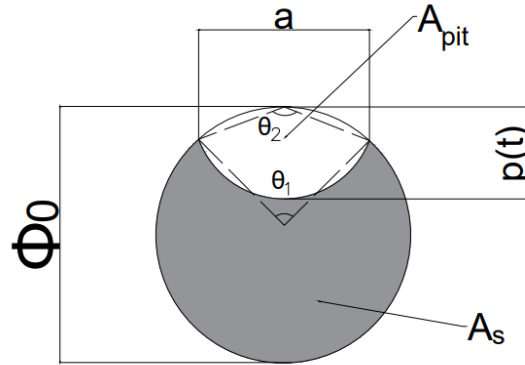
Geometria della corrosione per pitting su una barra di armatura
